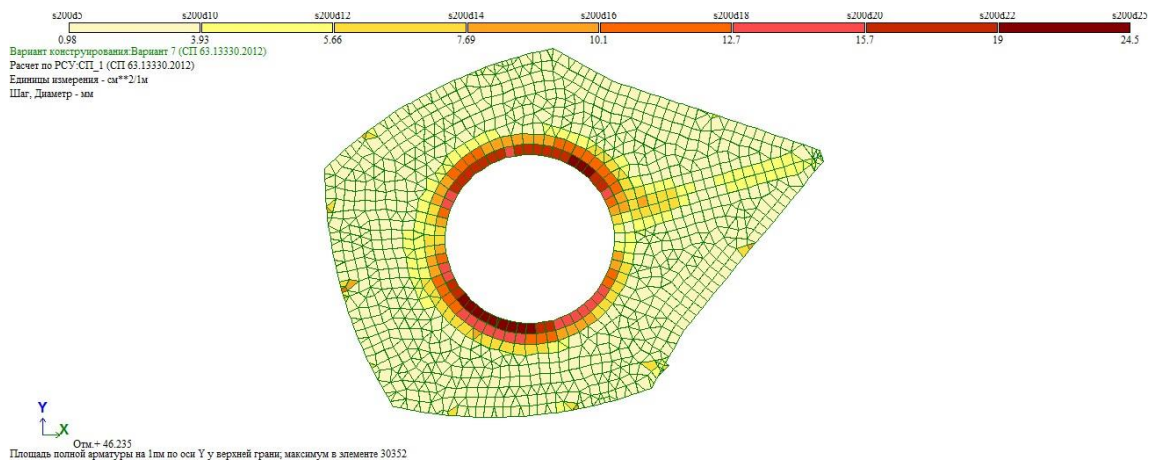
Изополя армування верхньою арматурою по осі y у плиті перекриття на відм. + 40.350
